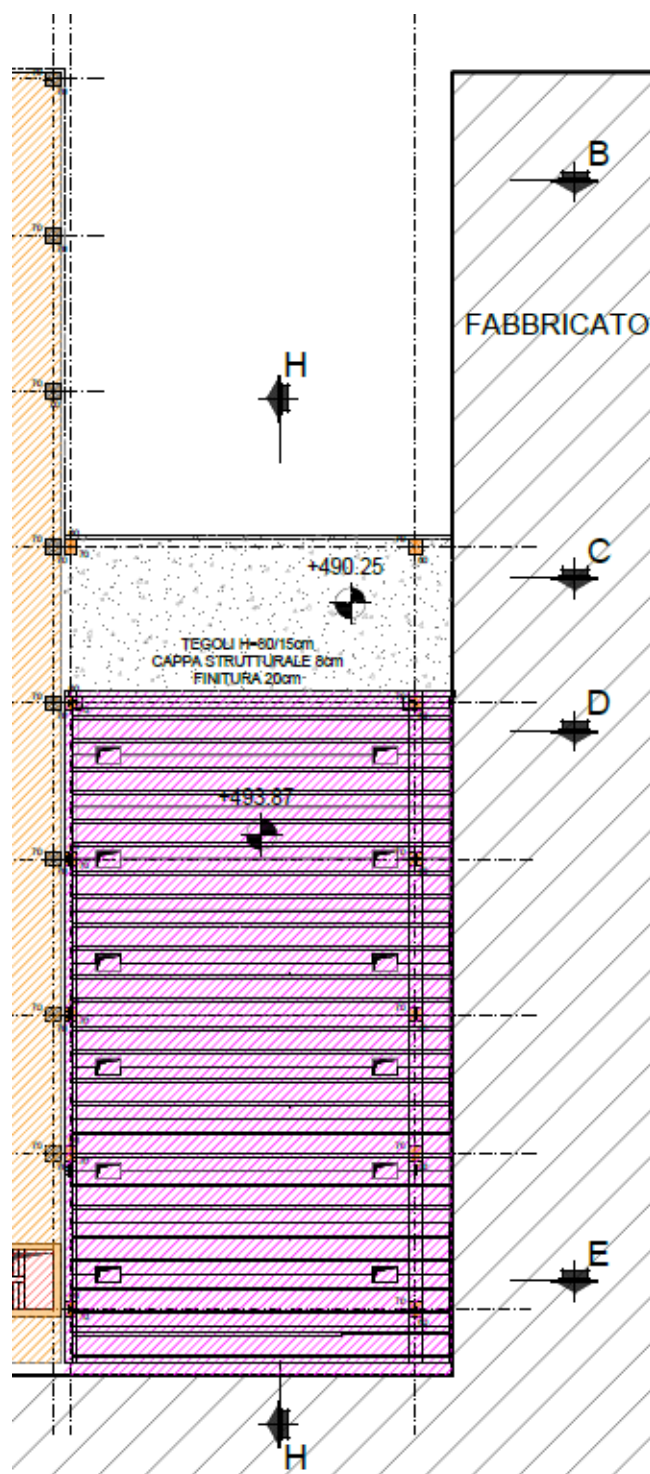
Planimetria piano P2 - Nuovo magazzino spedizioni
